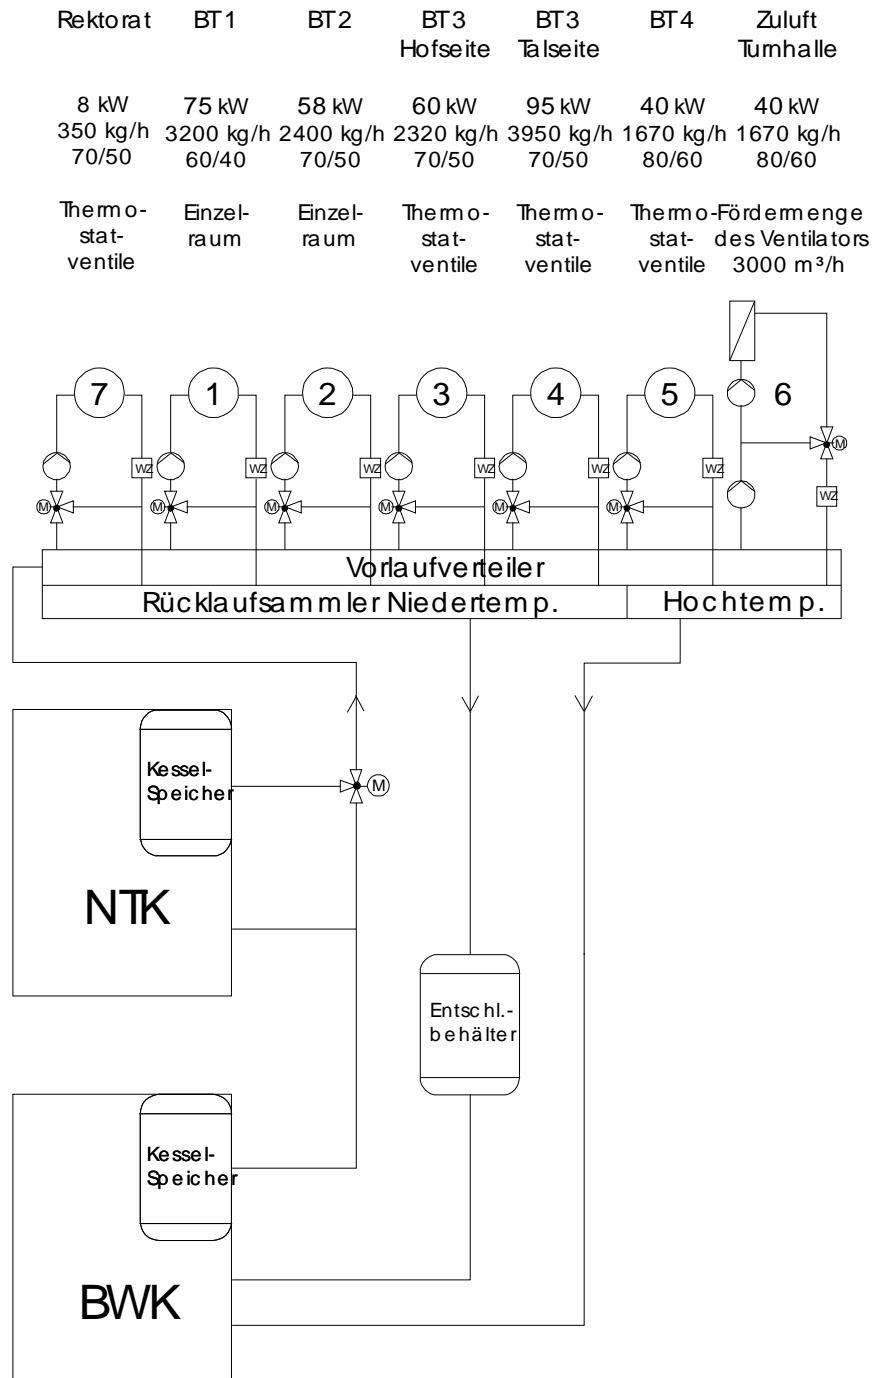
Schaltschema der neuen Heizungsanlage mit den einzelnen Heizkreisen.
